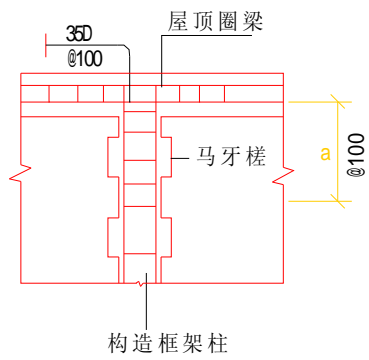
构造框架柱钢筋在顶层圈梁的锚固示意图
